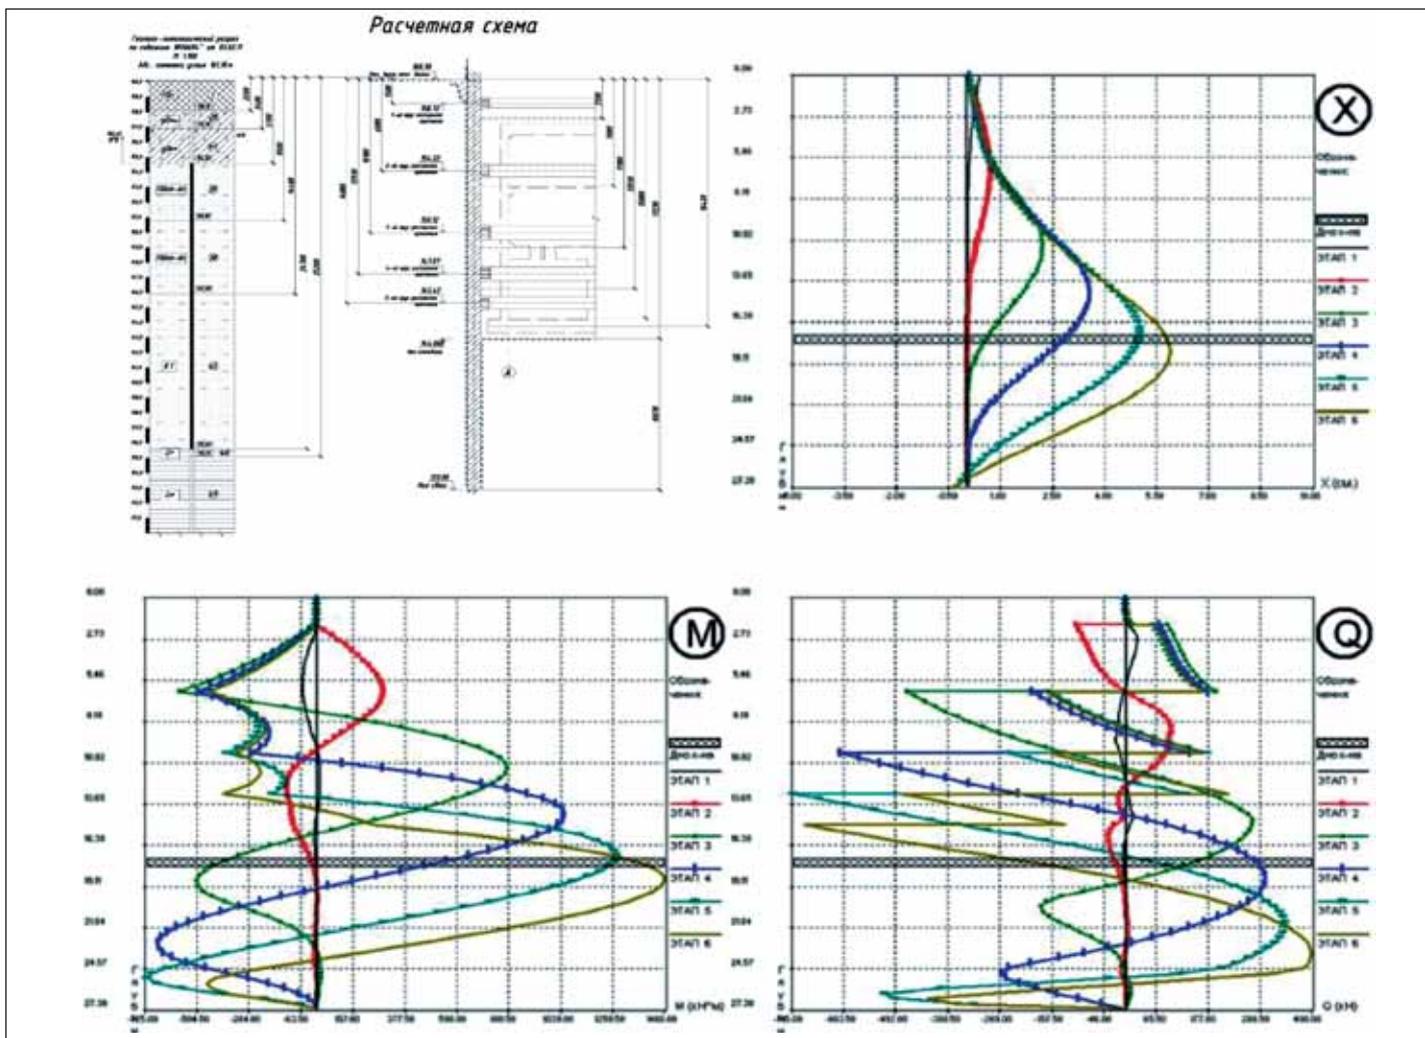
Расчетная схема крепления котлована. Эпюры в стене крепления (X – перемещения стены, M – изгибающих моментов, Q – поперечных сил)
